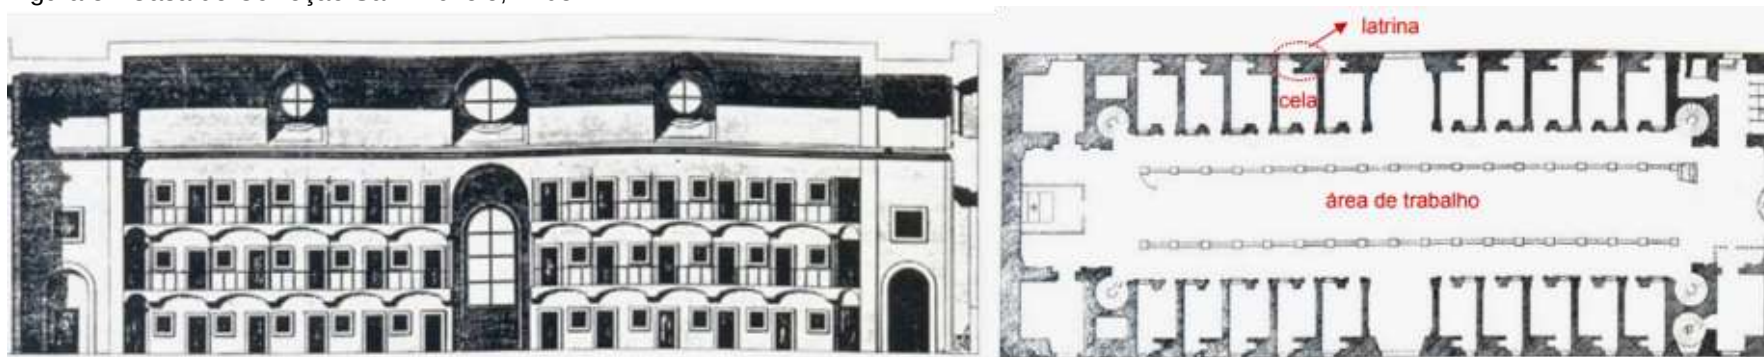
Planta da prisão do arquiteto Joseph Furtttenbach, 1635
